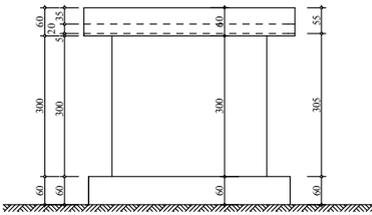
DETAILS SUR BATIMENTS EXISTANTS SUR LE SITE
